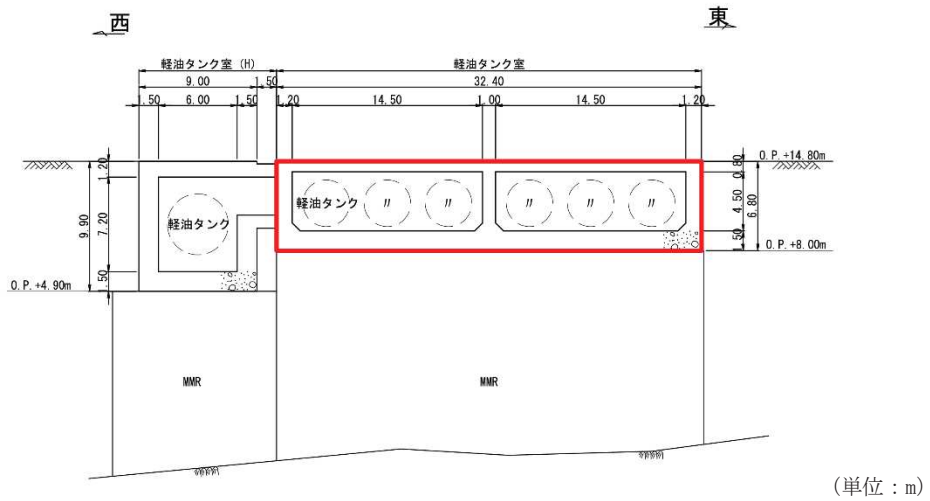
軽油タンク室断面図 (B-B 断面, 東西 (タンク室))
